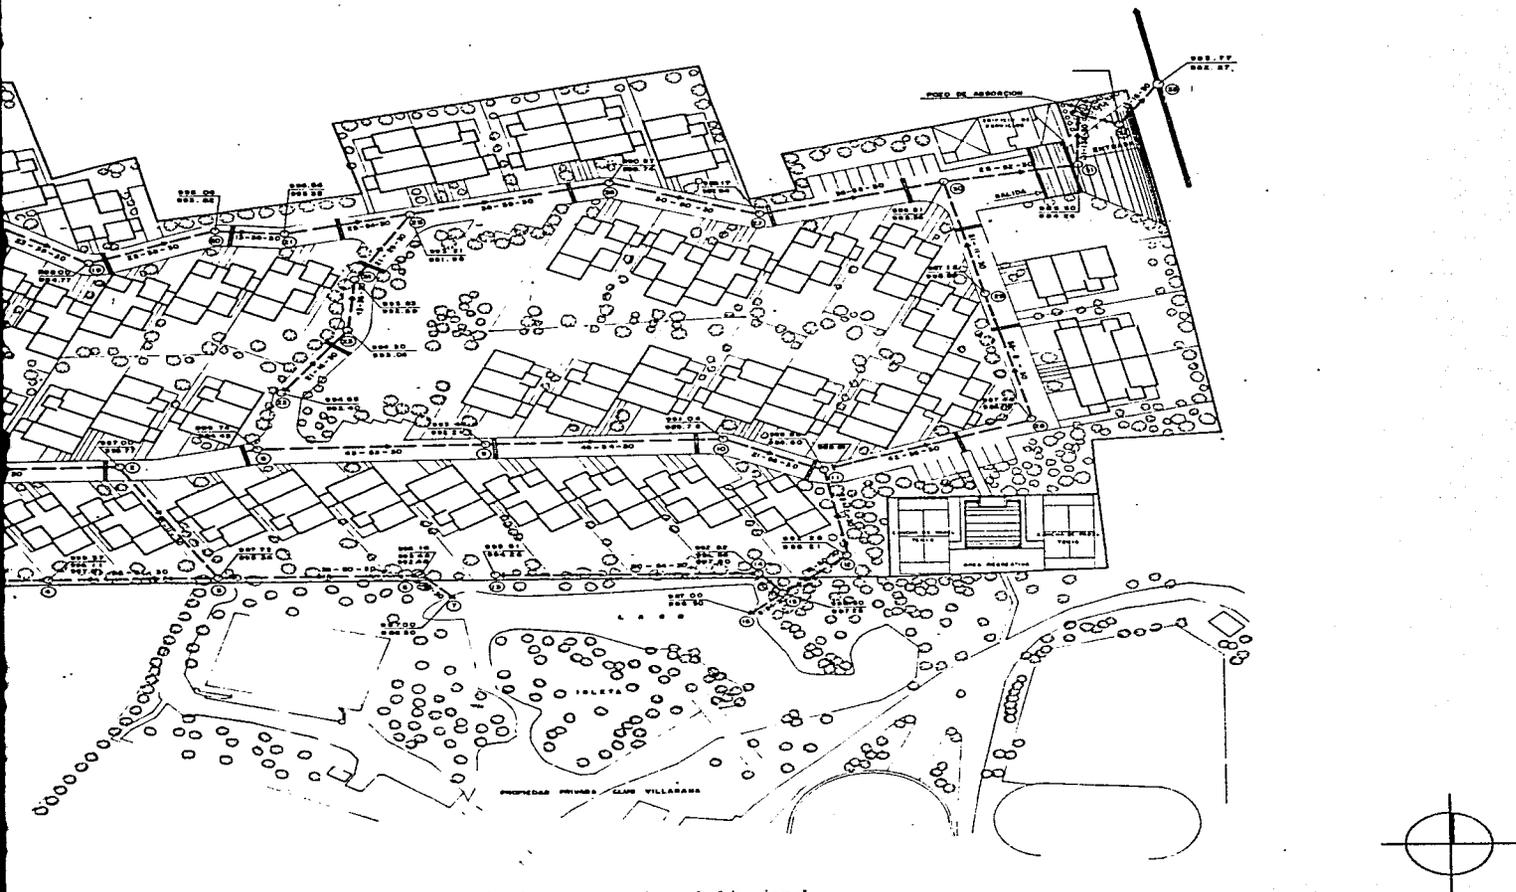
Plano de drenaje pluvial del conjunto habitacional
